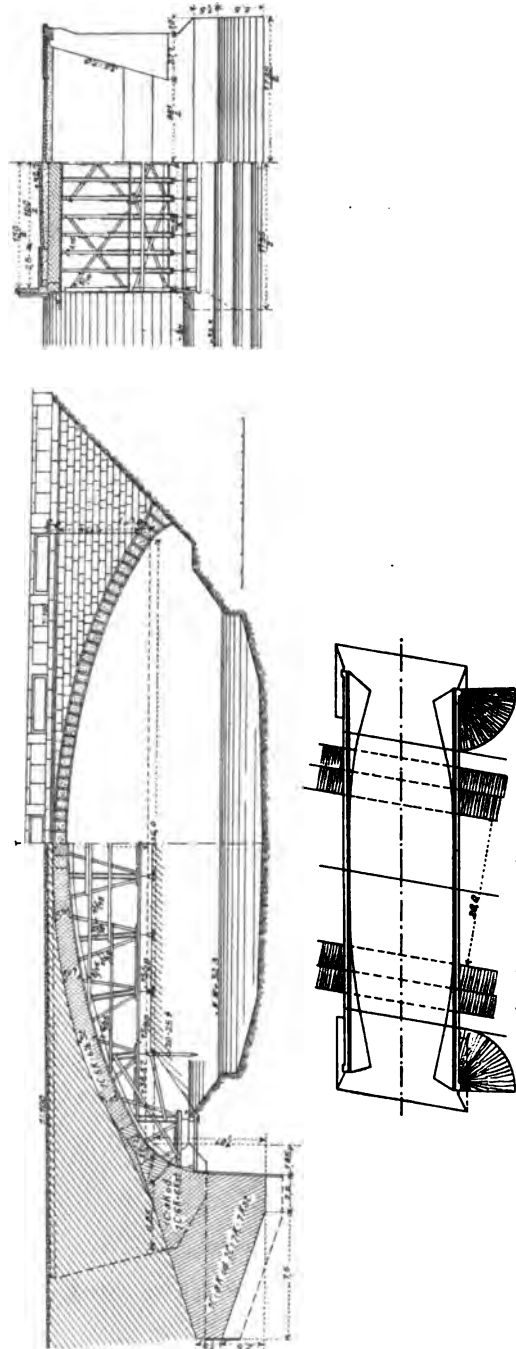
Schnitte und Grundrisse der Brücke über den Teltowkanal bei Britz.
